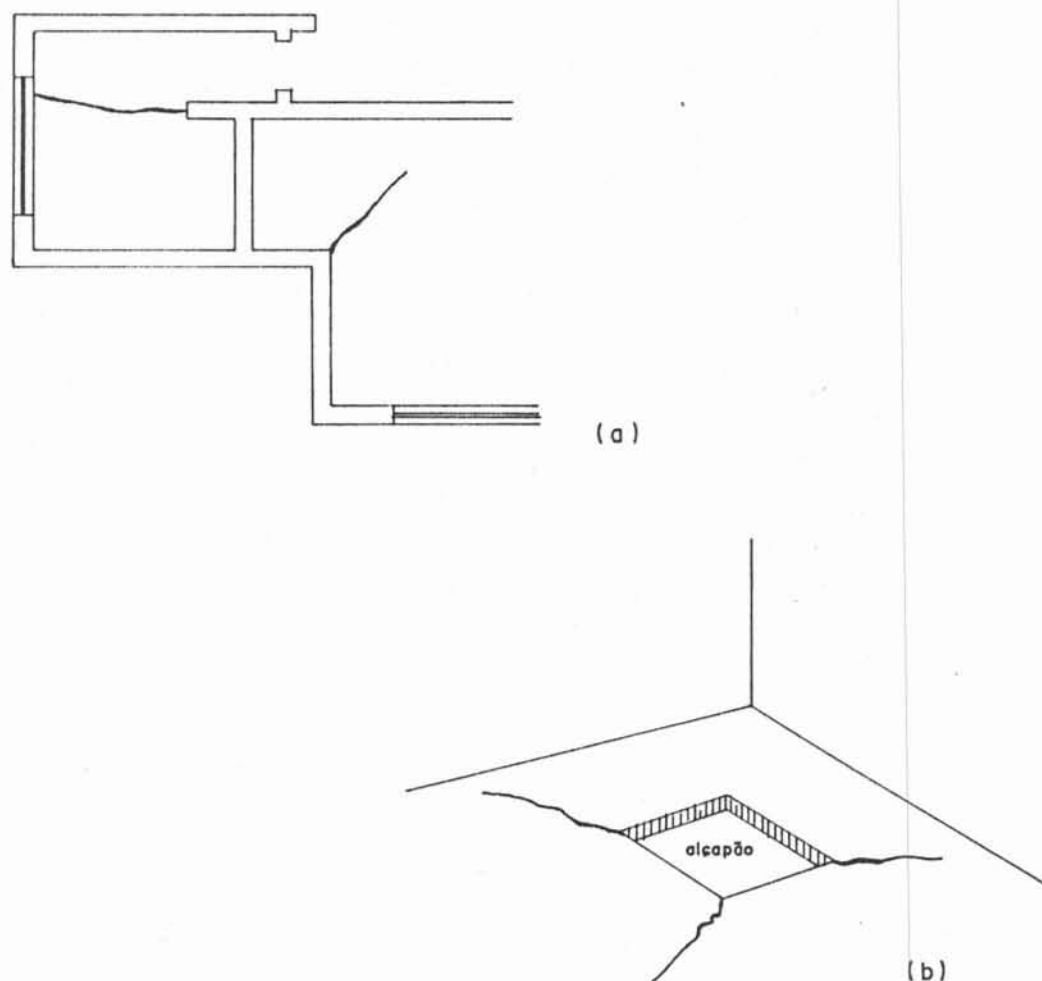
Fissuras em lajes pela inexistência de armadura capaz de absorver as tensões geradas nas mudanças de direção dos esforços.
